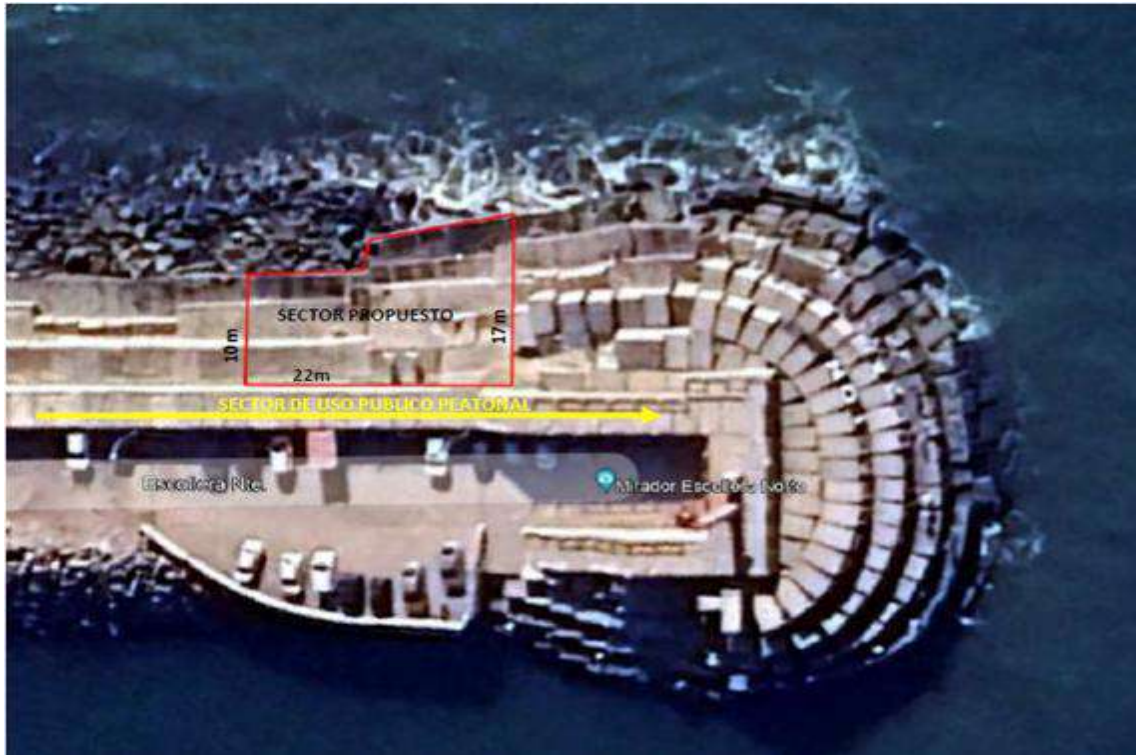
Demarcación del área afectada al proyecto en el extremo de la Escollera Norte.
